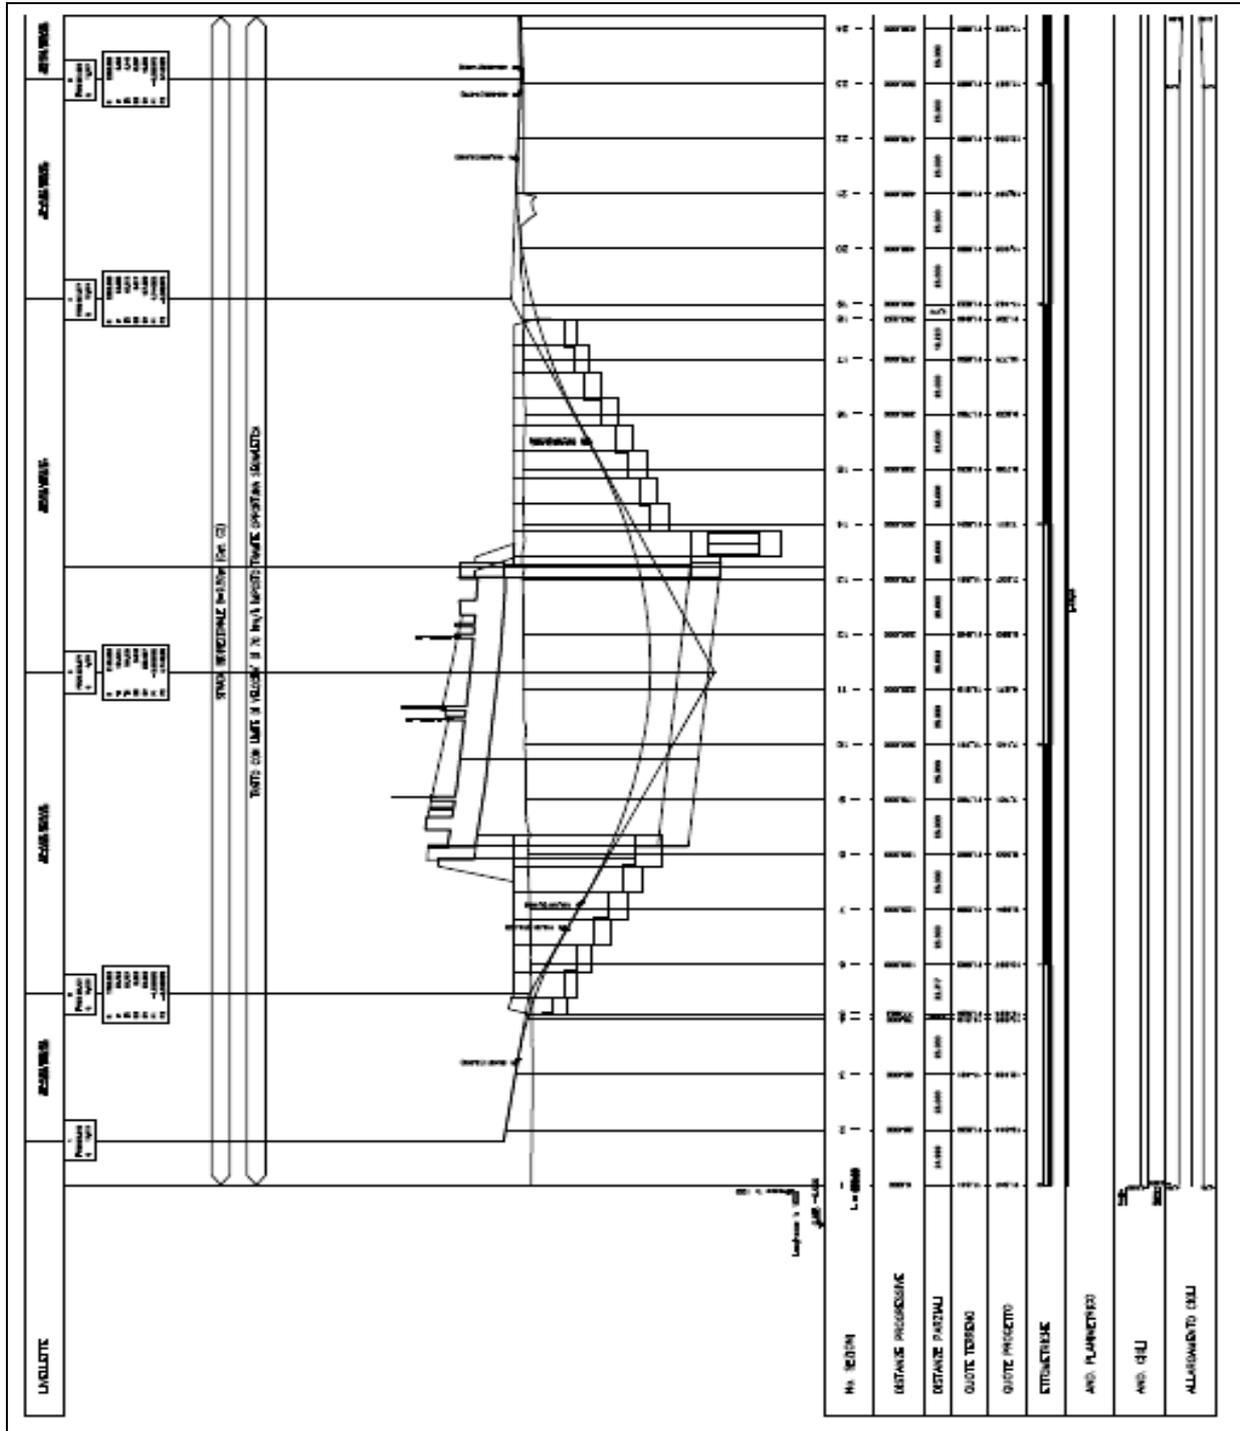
ESEMPIO DI INNALZAMENTO DEL PROFILO DI PROGETTO IN CORRISPONDENZA DELLE RAMPE DI ACCESSO AL SOTTOVIA
